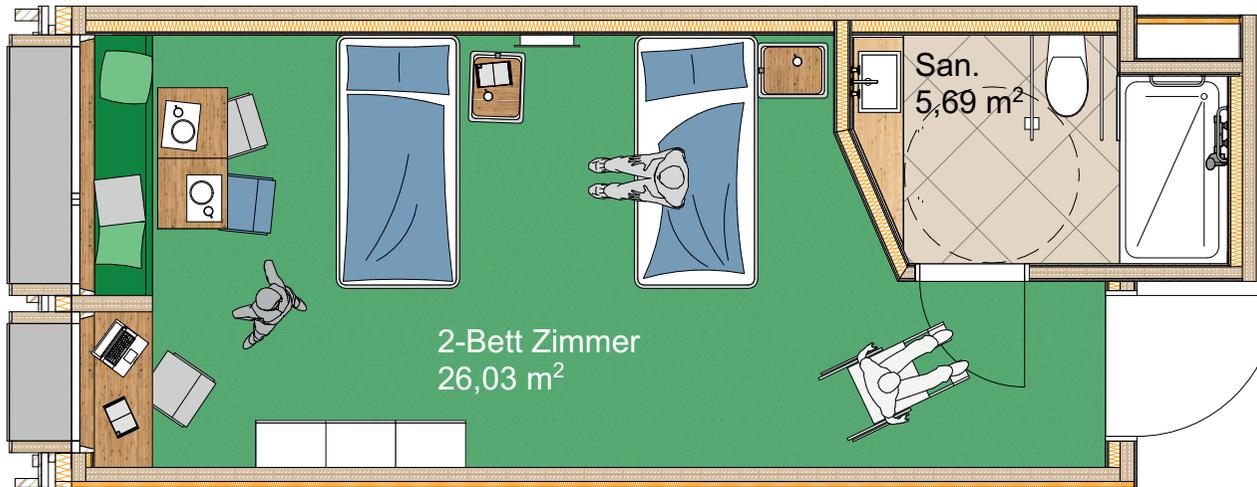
Grundriss Patientenzimmer - grünes Farbkonzept
